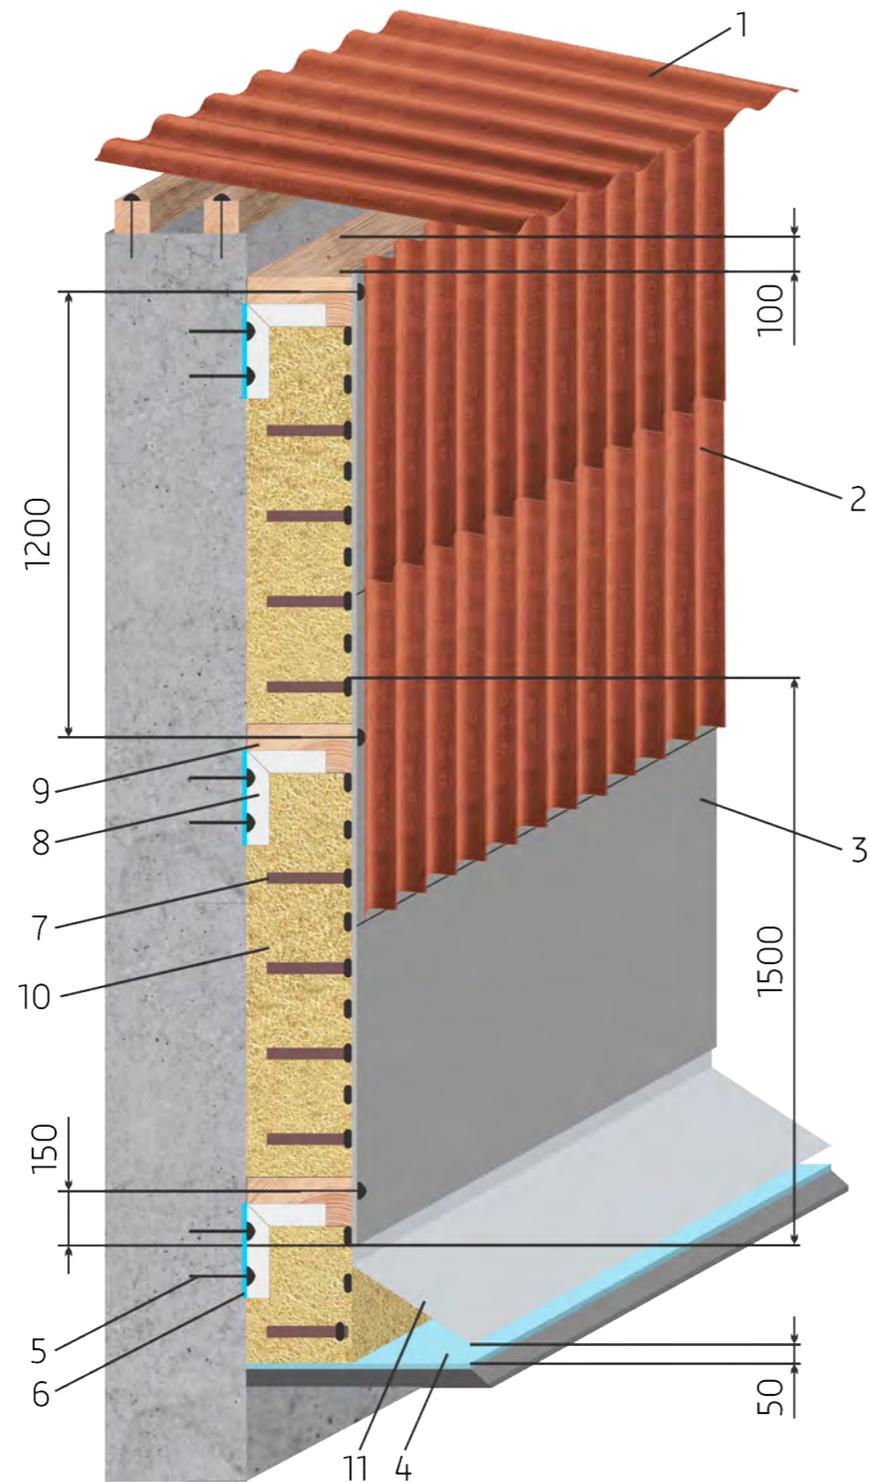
Утепленный вентилируемый фасад конструкции «Урал-1»
